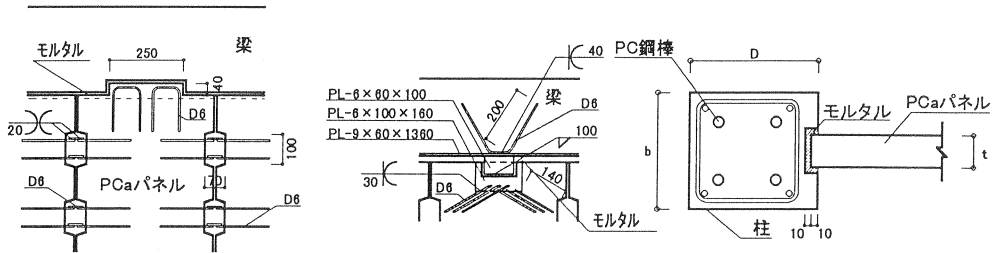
98PCWW-1.2の形状および配筋(単位:mm)
